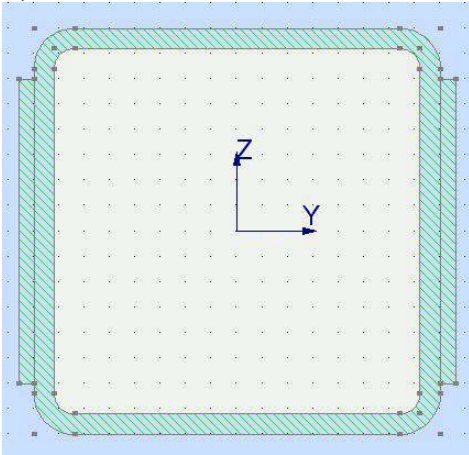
Стержни подстропильной фермы, требующие усиления
